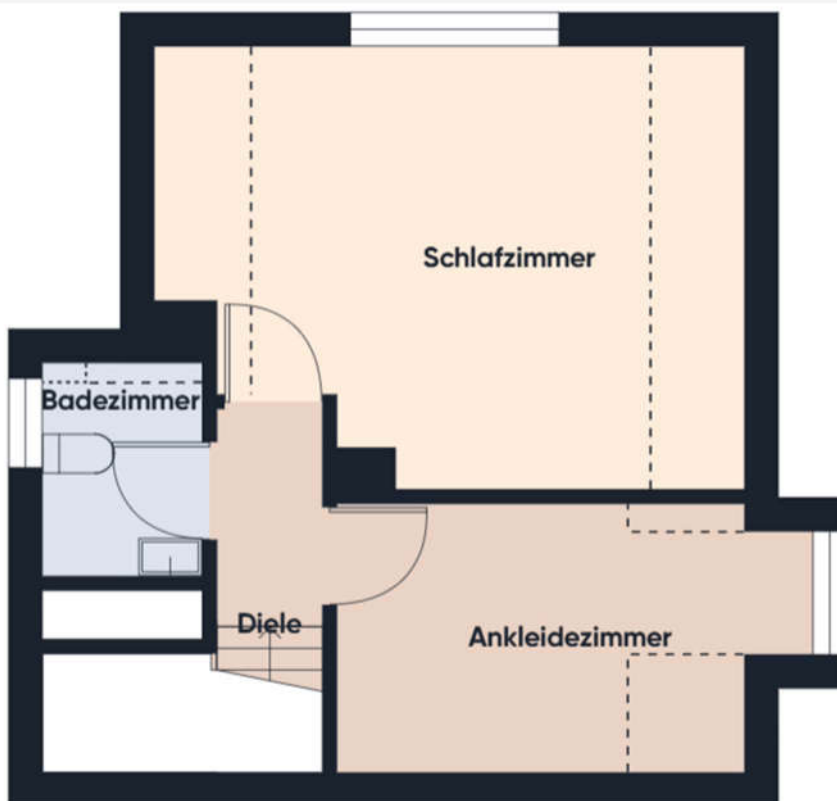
Grundriss Dachgeschoss aus dem Laser-Lidarmessgerät
